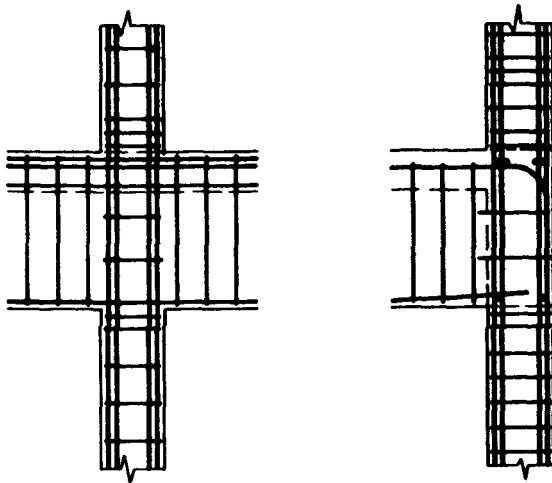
Anschlußkonstruktionen Stütze/Riegel der Stahlbetonstützen
